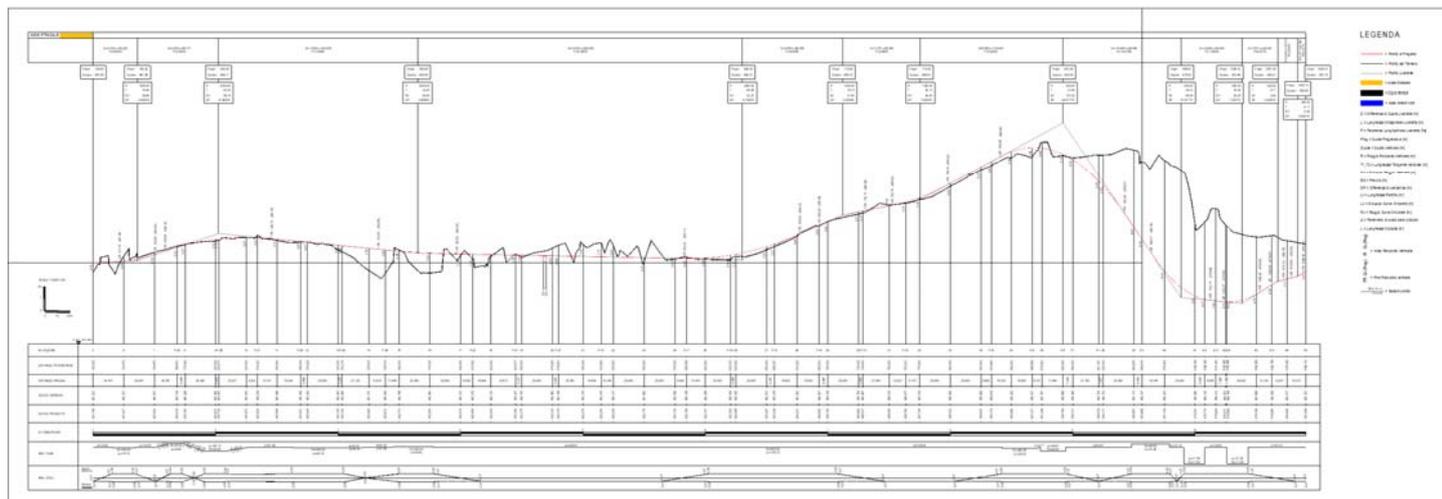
Profilo piano altimetrico della viabilità di sublotto funzionale
